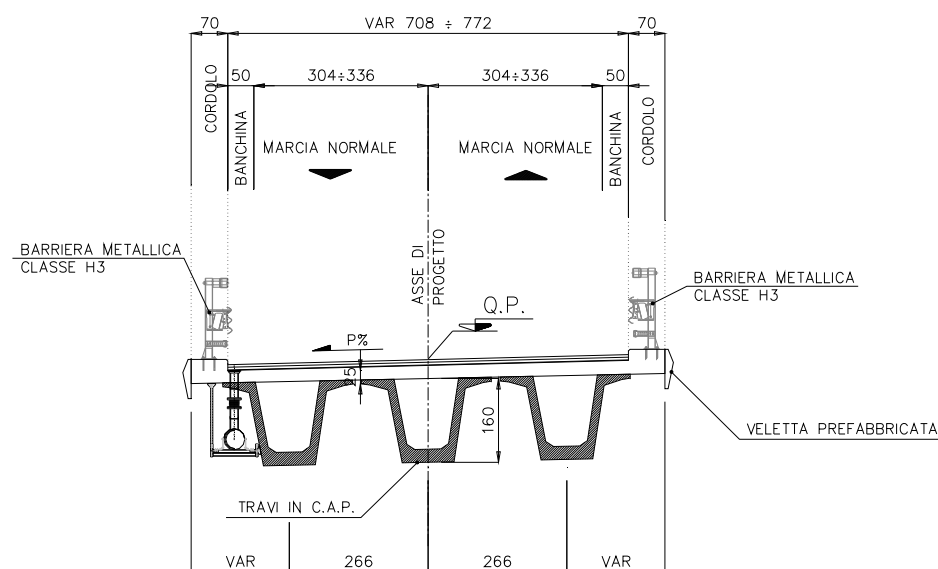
/3.2.3.1 - Sezione tipo impalcato Viadotto Montegemoli
